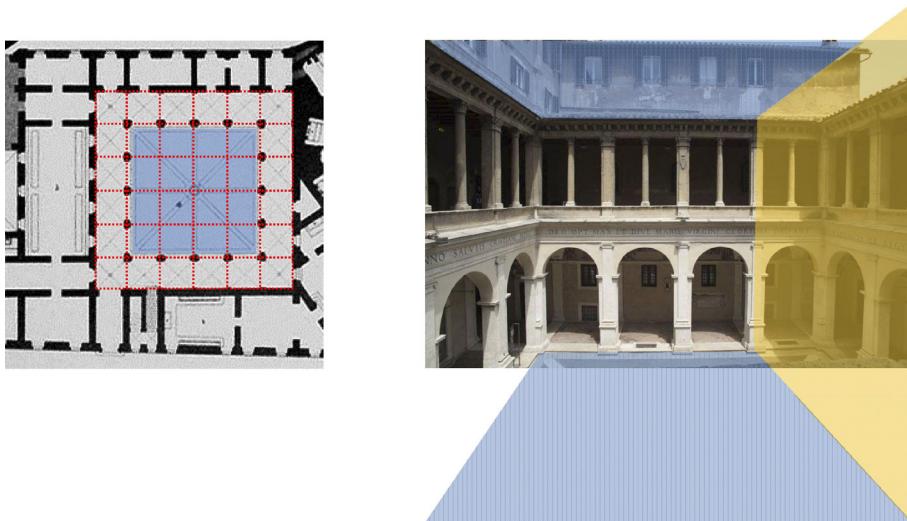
Bramante: fragmento de la planta del *chiostro* de Santa María della Pace y vista del interior del patio con fotomontaje a partir de la hipótesis de espacio cúbico según el trazado inicial de 3x3 vanos. Fuente: elaboración propia a partir de planta de Letarouilly y fotografía del autor.
